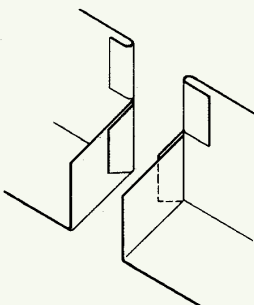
Bovenaansluiting, voor nok en keper a dakbaan details
